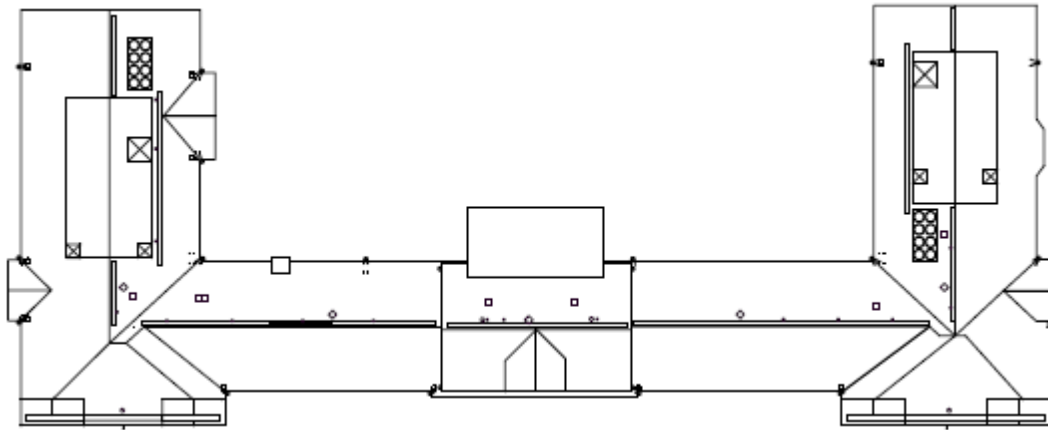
Puretun pintalaatan alla olevat betonoidut I-palkit. 2. kerroksen lattia.
